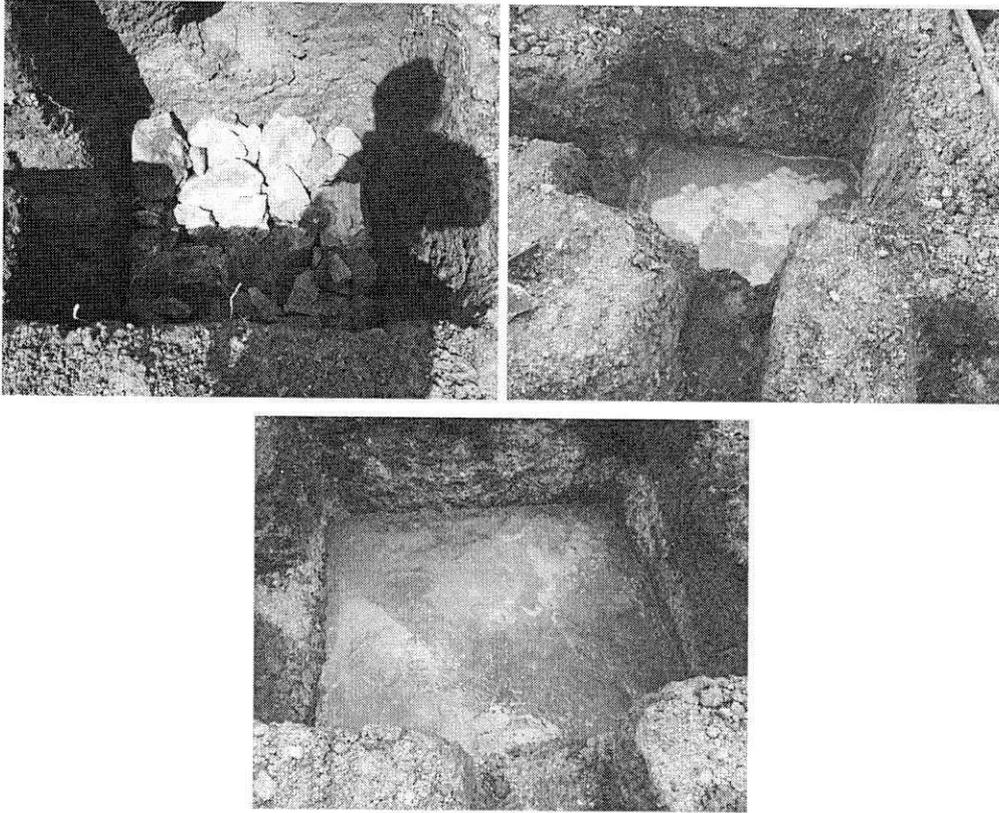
a 47 – Colocação das pedras para o baldrame e sapatas e nivelamento com concreto magro
